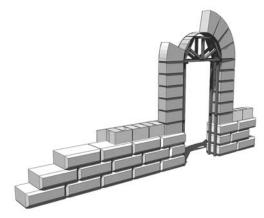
Representación del posible montaje de las piezas prefabricadas de los vanos de planta baja mediante el uso de cimbras
